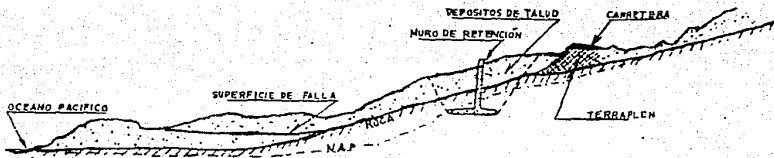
Croquis de una falla en ladera, con un muro de retención. Km 16 + 000 de la autopista Tijuana-Emanada.
